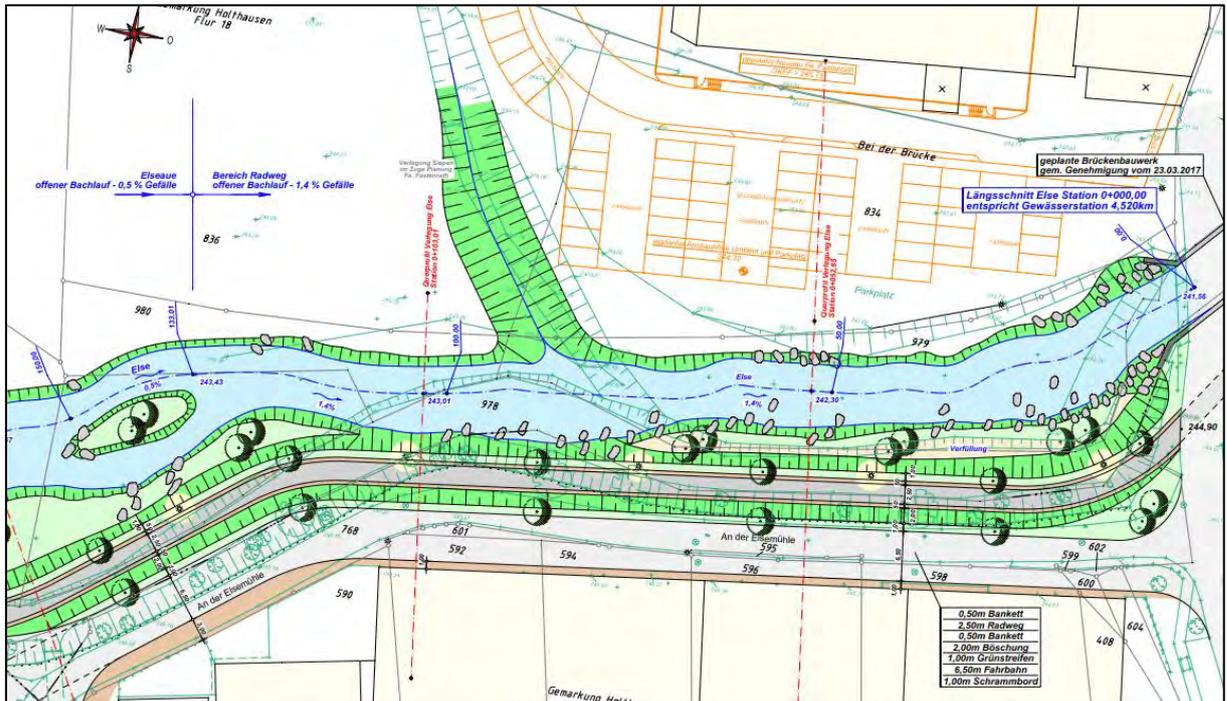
Planung Abschnitt der Else am neuen Radweg (Ausschnitt Lageplan)
